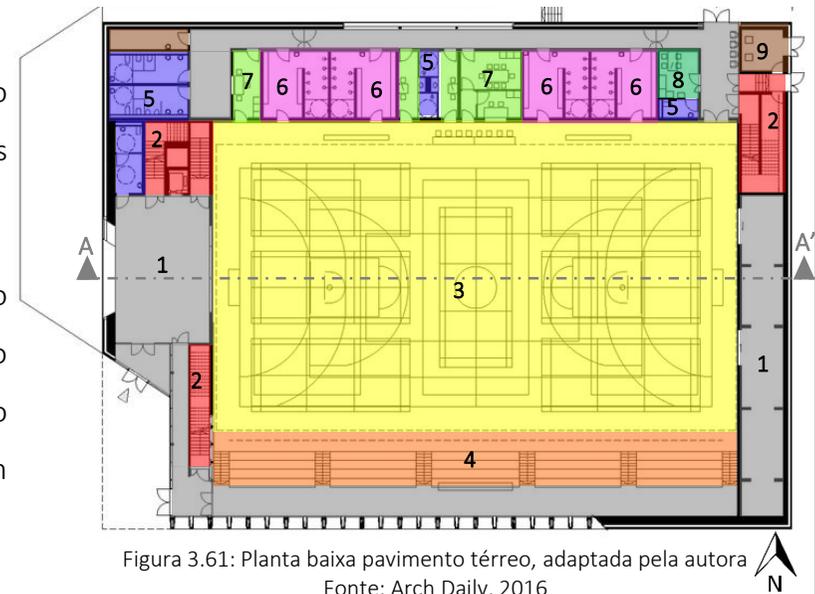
Planta baixa pavimento térreo, adaptada pela autora
